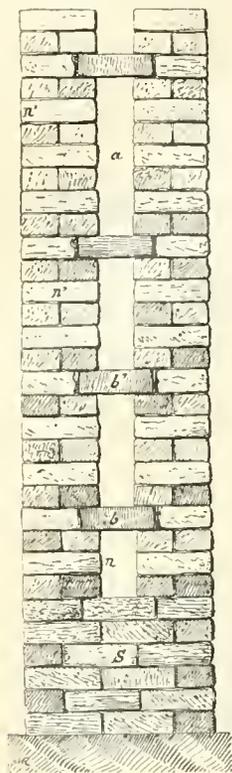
Coupe verticale d'un mur isolant en briques.
